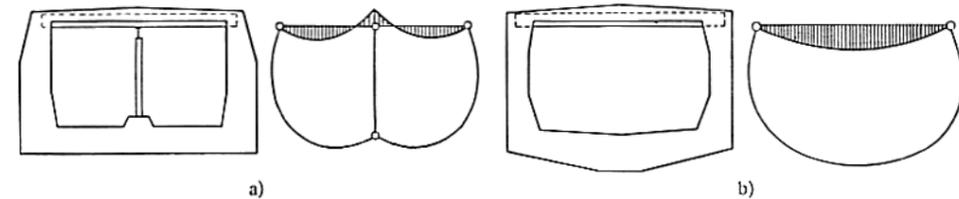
Tunneltrög aus reinem Stampfbeton. Decke I-Träger, dazwischen Betonkappen.
